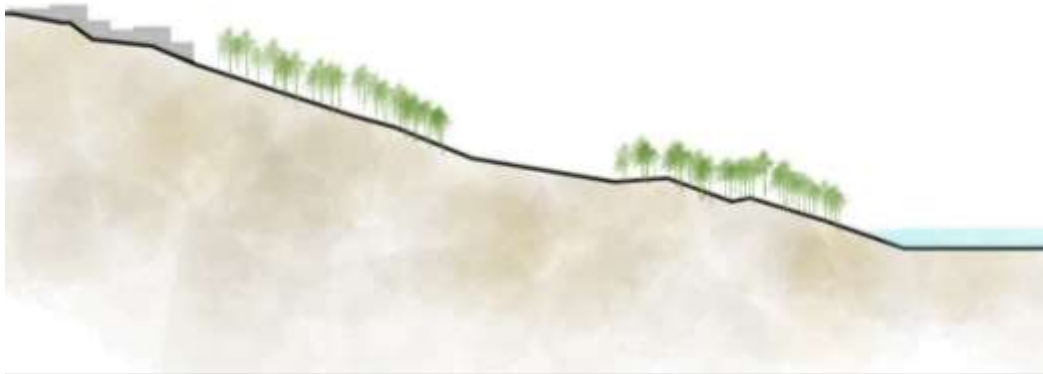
Perfil de Zona de intervención. Fuente: Elaboración Propia.
